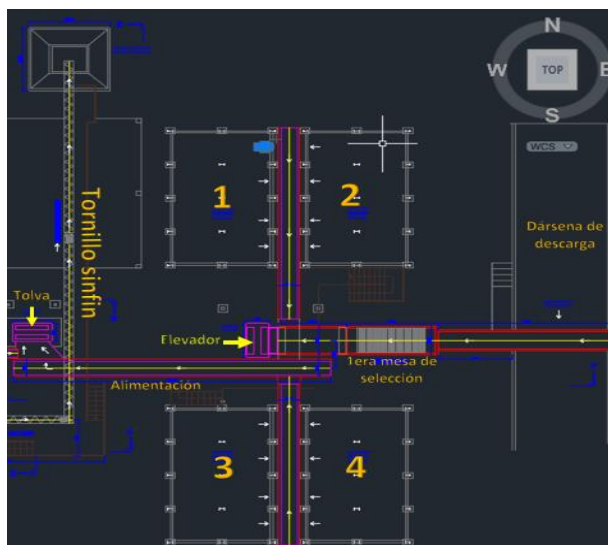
Layout de la descarga de fruta y el stock.
